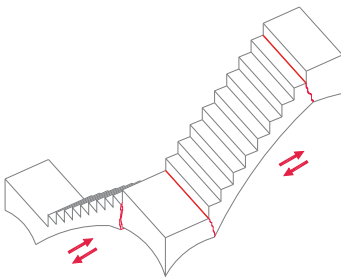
<sup>38</sup>: Imagen Grietas escalera casa Irurita.
